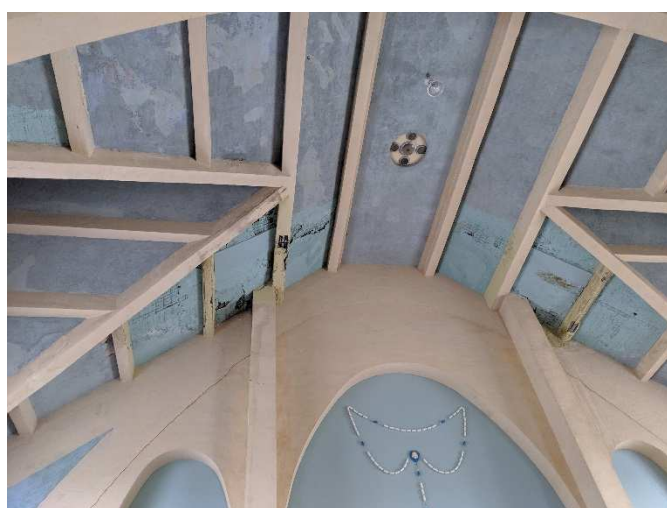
Arche de l'entrée – Fissure sur la périphérie – Janvier 2013
